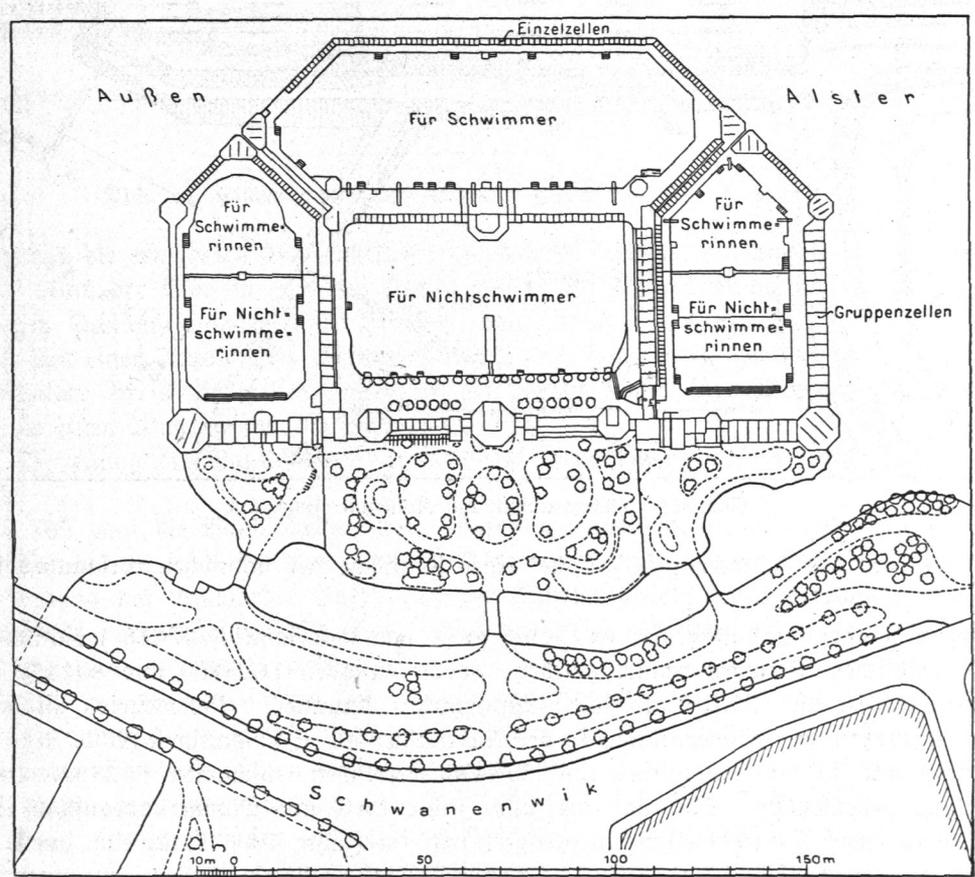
Badeanstalt Schwanenwik, Lageplan.
